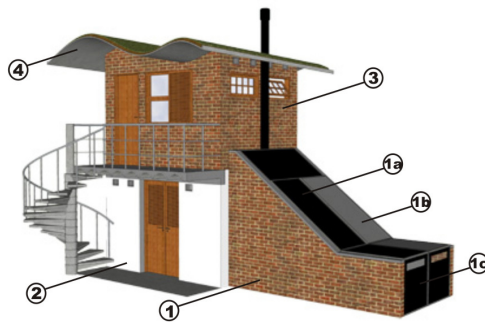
Vista da maquete – fachadas leste e norte (Autor: Lucas Sabino Dias).
